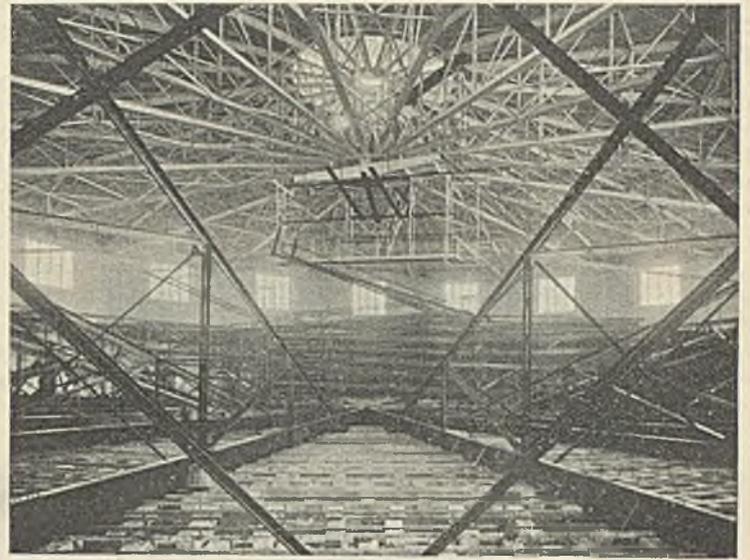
Scheibe und Dachgesperre des Gasbehälters während des Baues.
